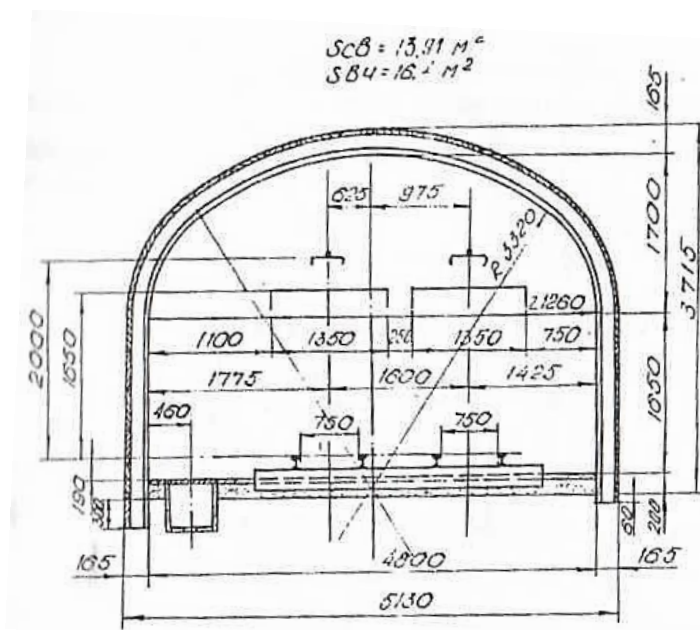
Сечение горно-капитальной выработки, закрепленной металлической арочной крепью с затяжкой кровли и бортов железобетонными «досками»
